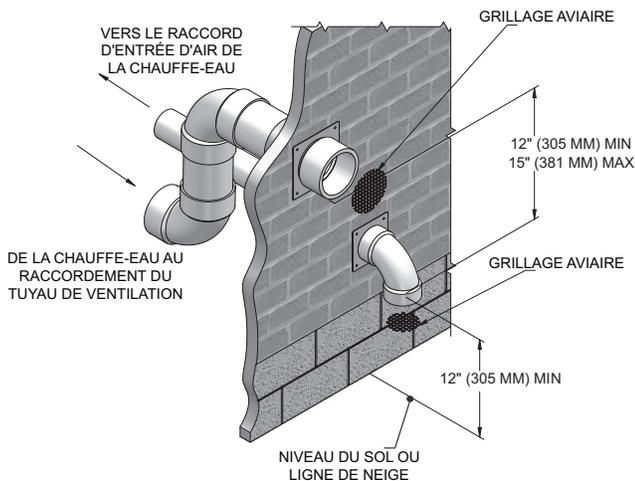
C Autre terminaison de ventilation en PVC/CPVC/SS - Terminaison murale classique en acier inoxydable air et ventilation avec raccords fournis sur place
